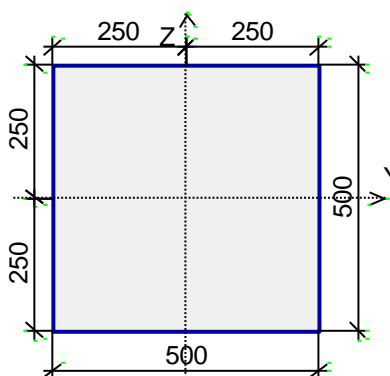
Сечение центрально нагруженной железобетонной колонны
